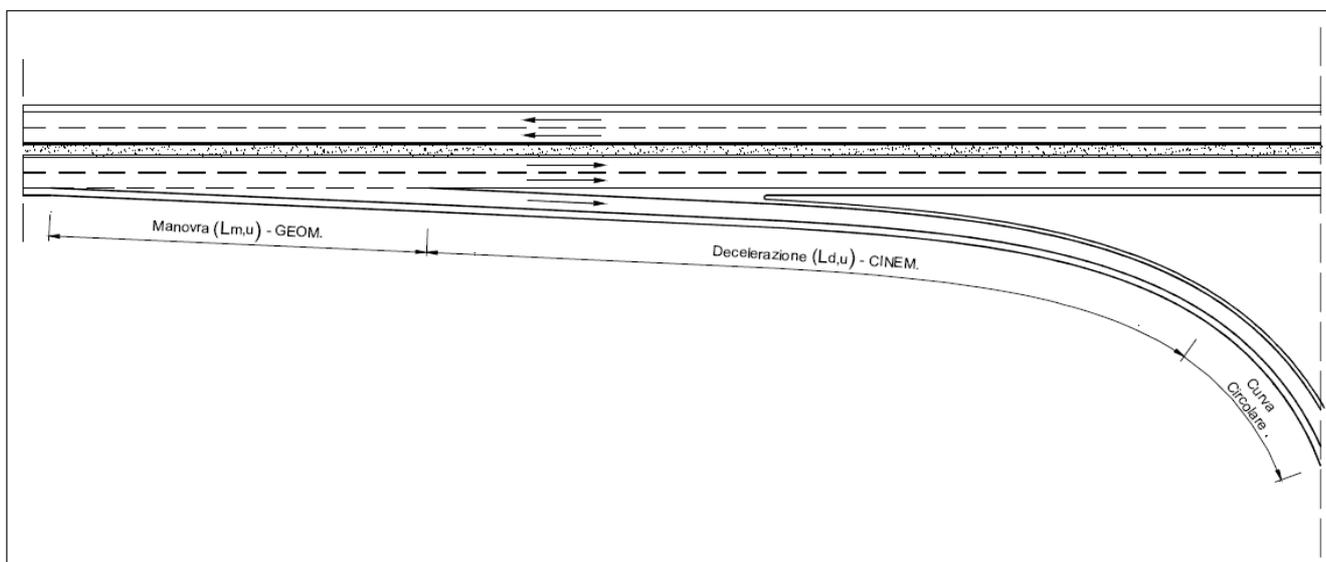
Schema planimetrico corsia di diversione - tipologia ad ago
